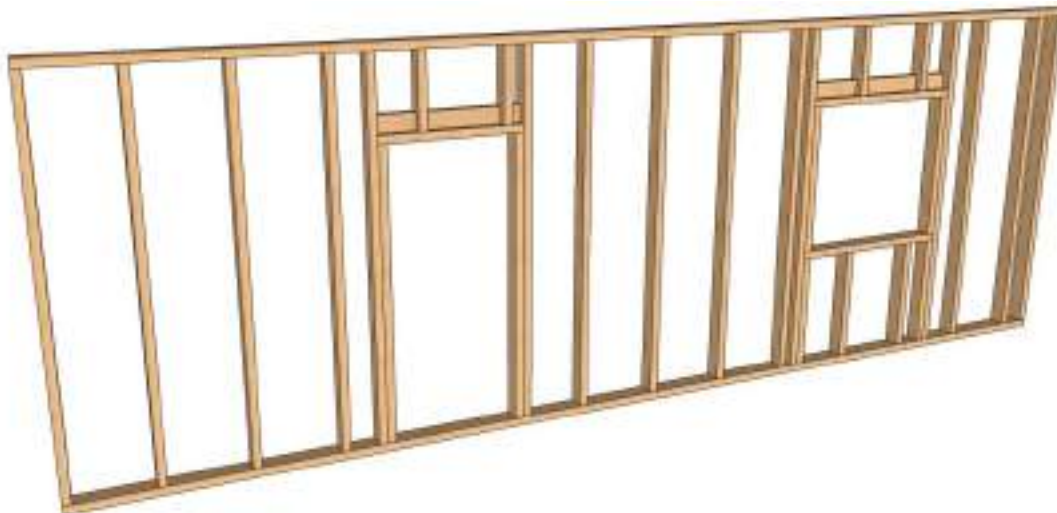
Vue de l'ossature bois intérieure (section rectangulaire) d'un panneau de mur structurel LogiWall
